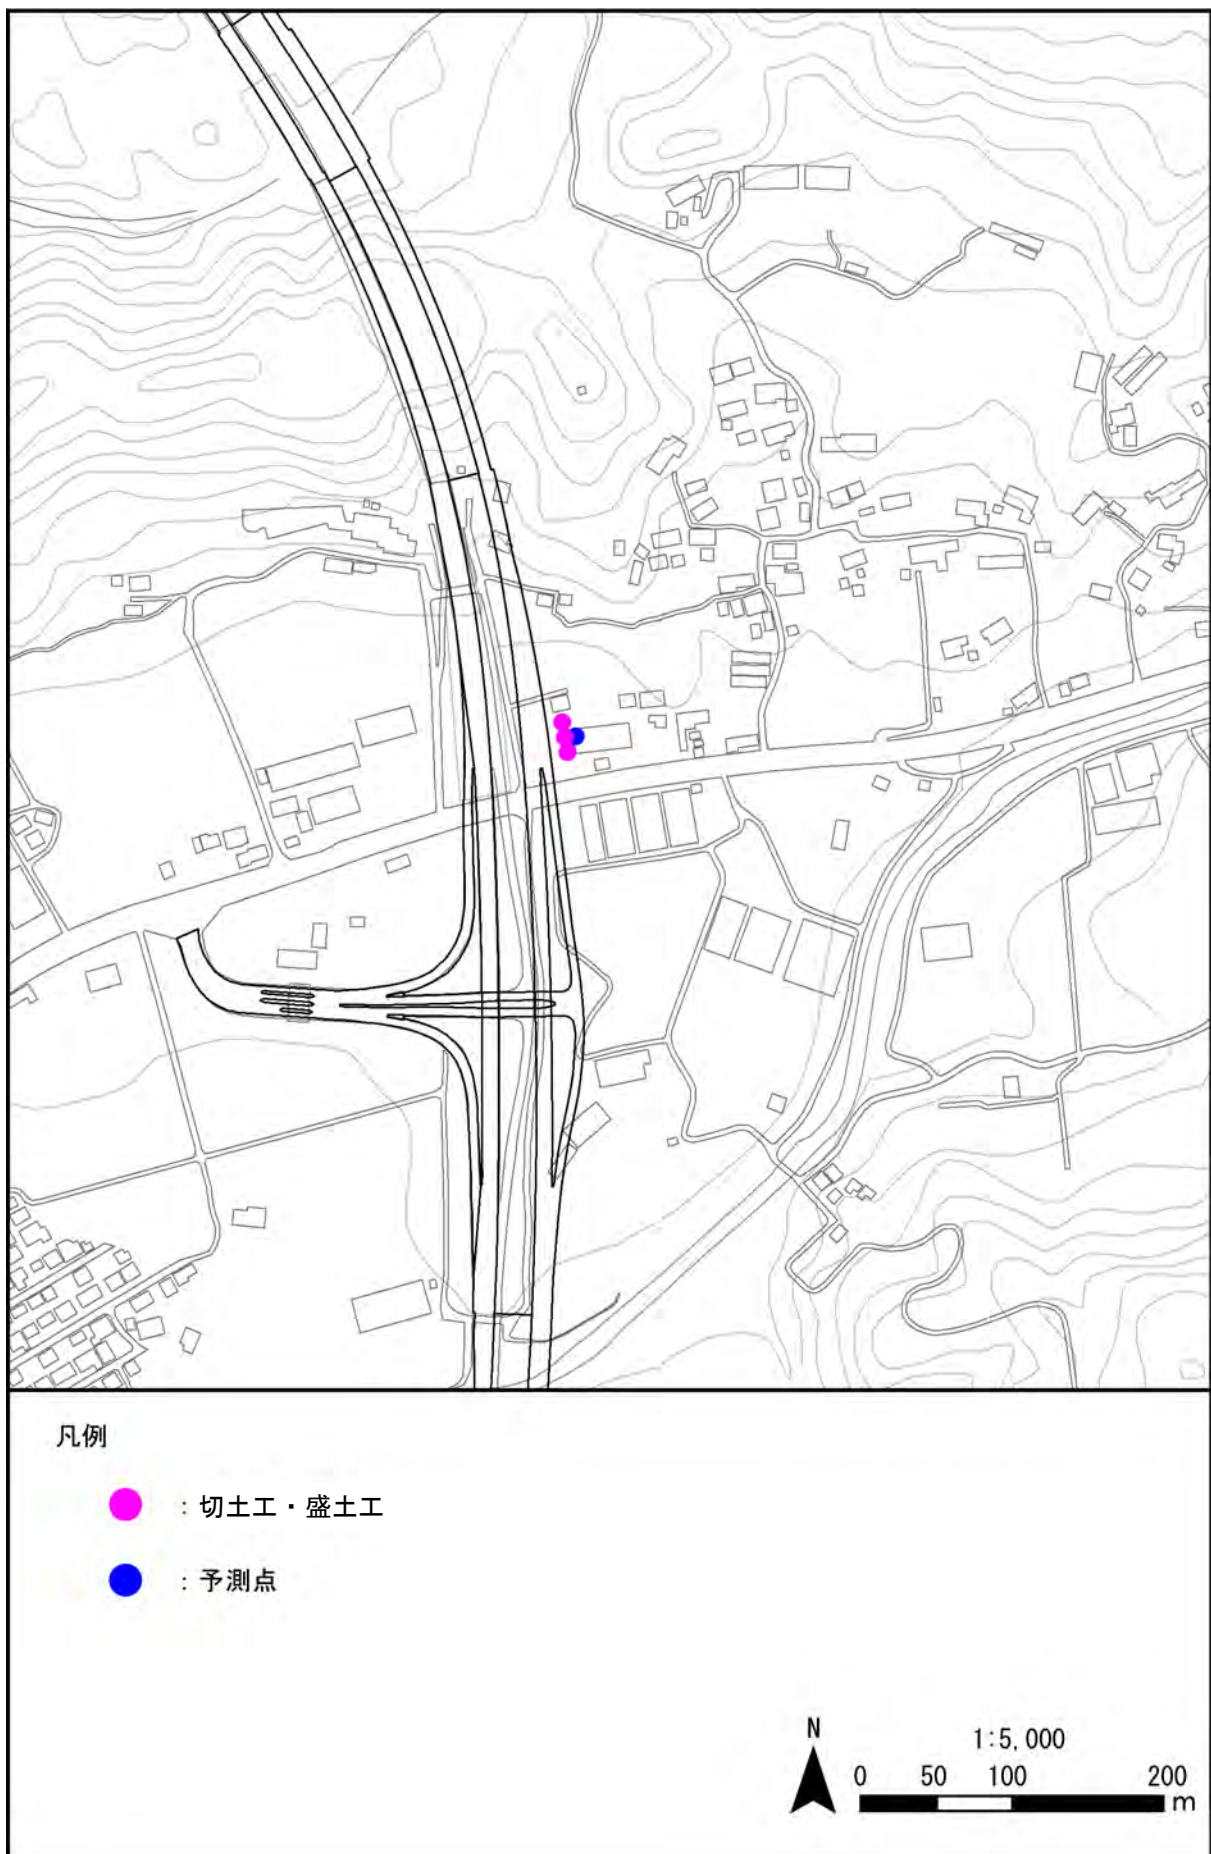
(4) 建設機械の稼働に係る振動のユニット配置図 (4 鋸南保田 IC 付近)
